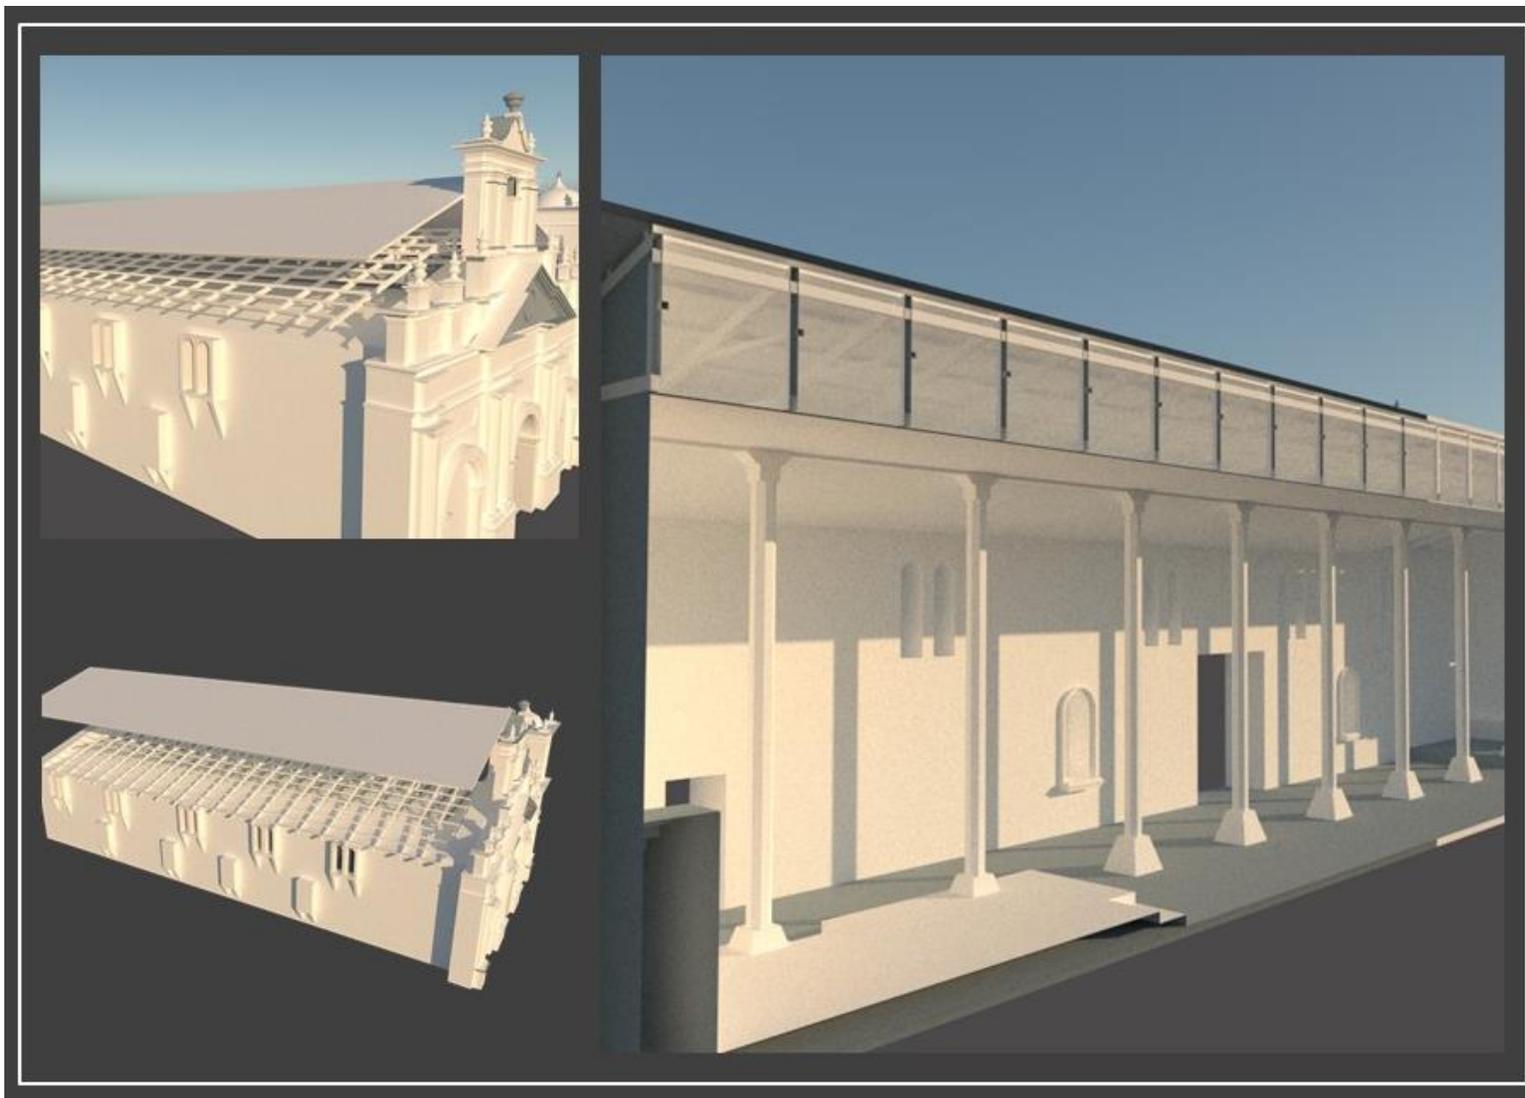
Modelo de estructura de techo. Fuente: elaboración propia.
